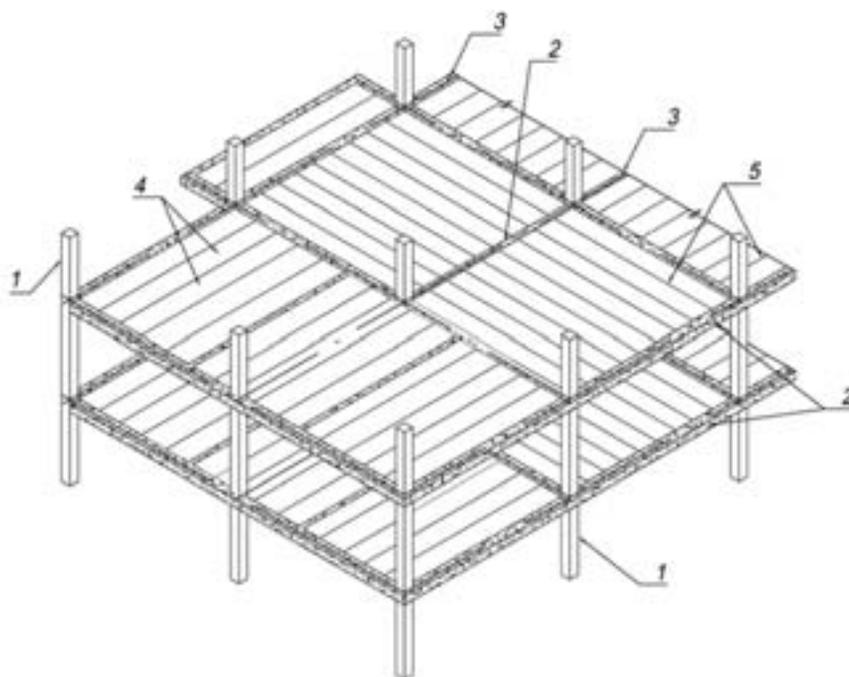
Принципиальная схема сталебетонного каркаса: 1 — стальные (сталебетонные) колонны; 2 — несущие ригели; 3 — связевые ригели; 4 — газобетонные плиты перекрытия; 5 — межплитные швы
